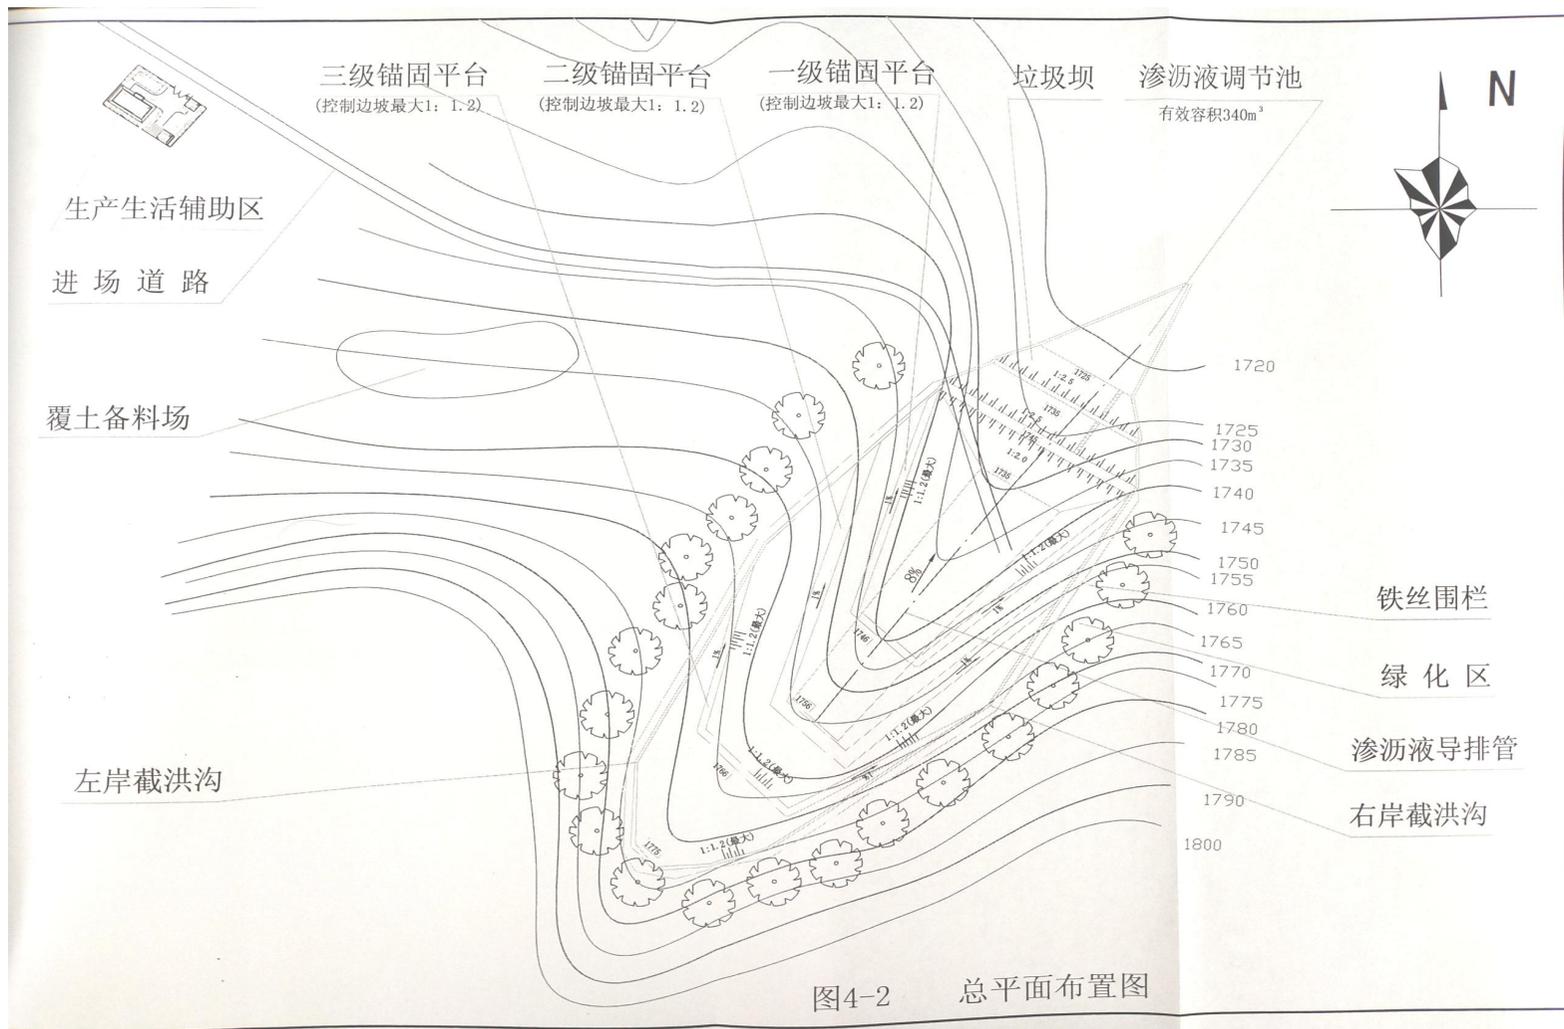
静宁县界石铺生活垃圾填埋场平面布置图
